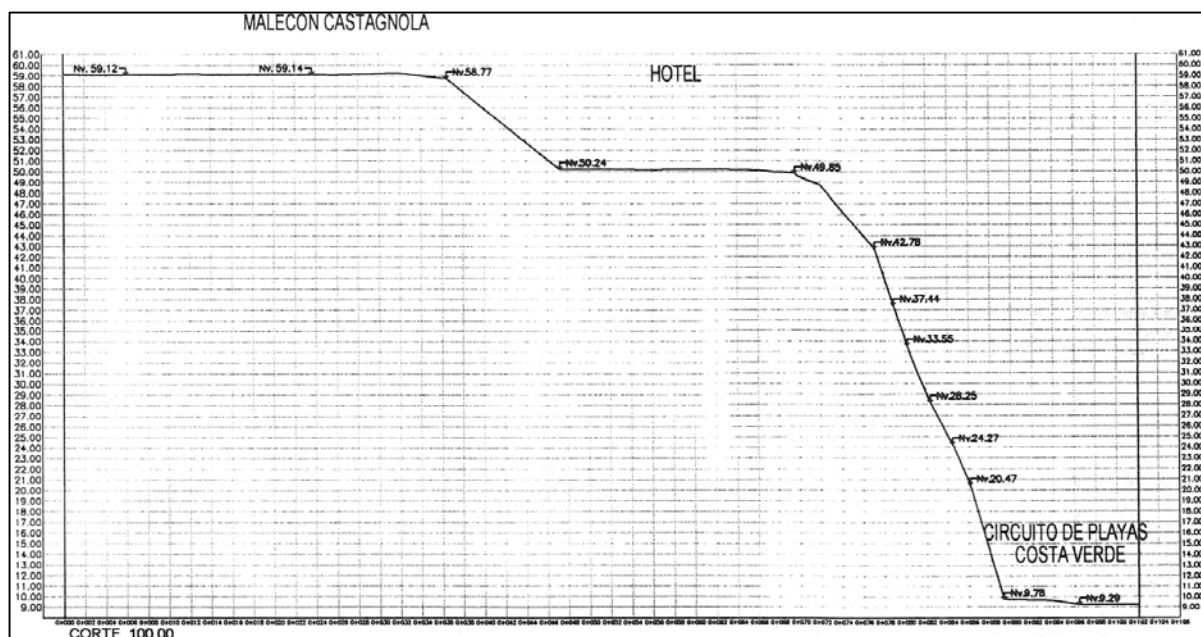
Levantamiento topográfico Malecón Castagnola - Vista en alzado (Terreno Natural en la sección 5-5)
